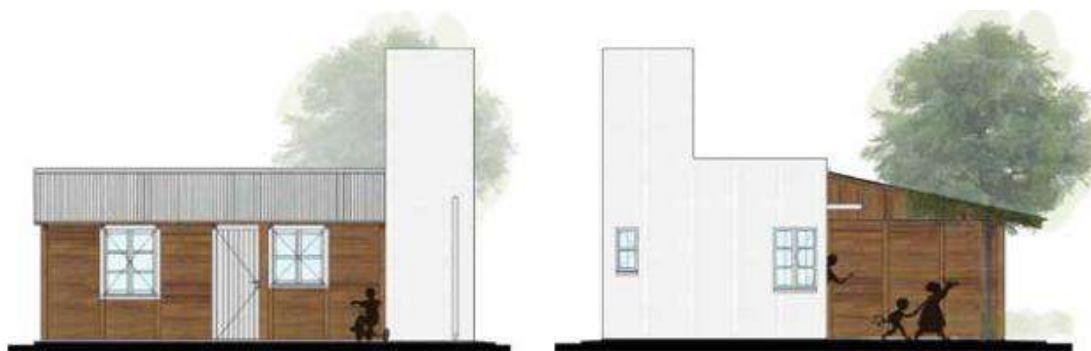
Vista frontal y vista lateral de una vivienda tipo. Fuente: Peyloubet, Paula (et al., 2108). Co-construyendo tecnología: De la confianza al afecto pasando por los saberes
